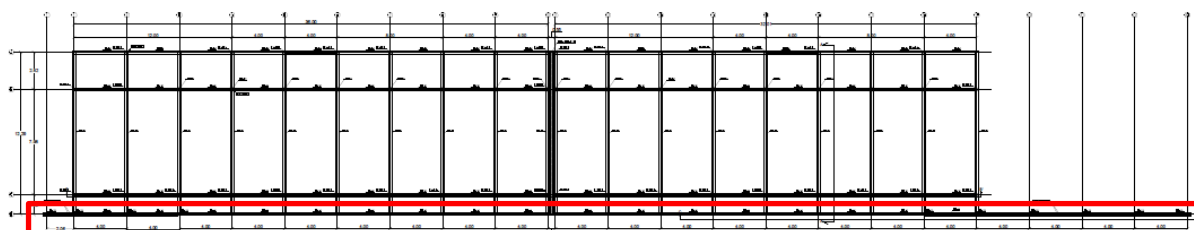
Pianta piano terra – strutturale – Individuazione della parete
